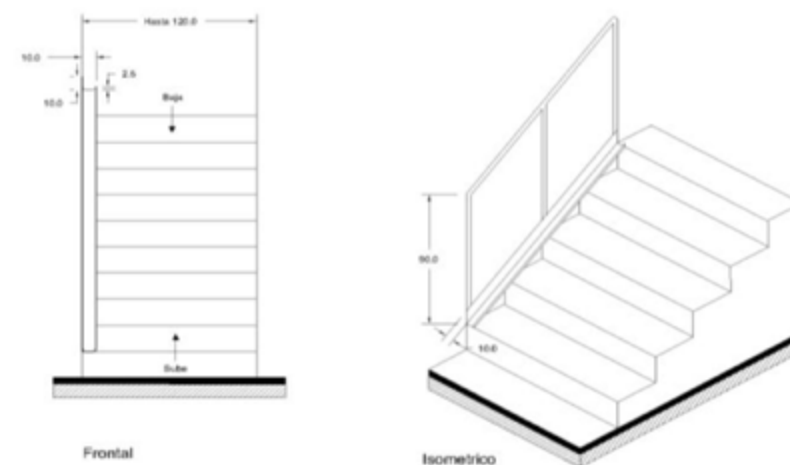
A. Rampa ciclista en escaleras con un ancho de hasta 1.20 m.
